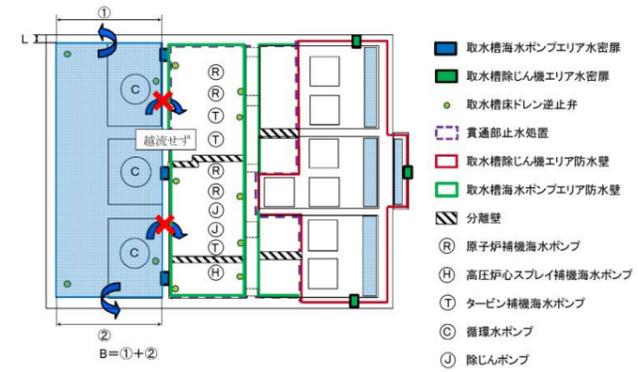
取水槽海水ポンプエリア平面図 (循環水系配管破損時)
